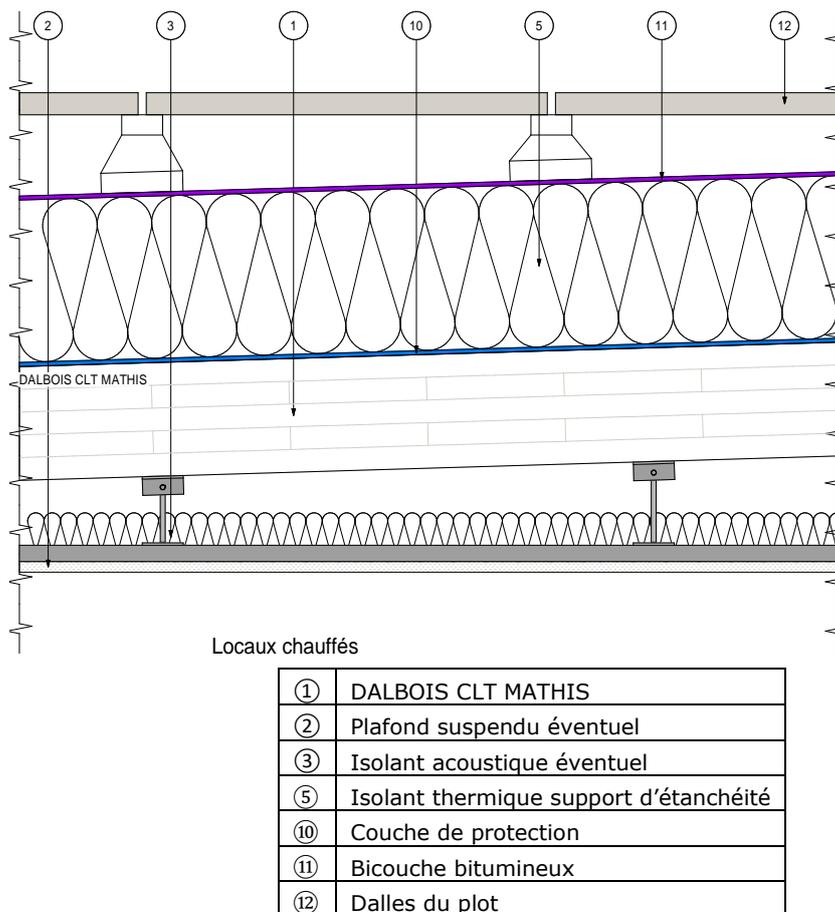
Utilisation d'un CLT DALBOIS CLT-M en configuration de toiture isolée sur bâtiment chauffé– Toiture accessible aux piétons et au séjour – Protection par dalles sur plot
